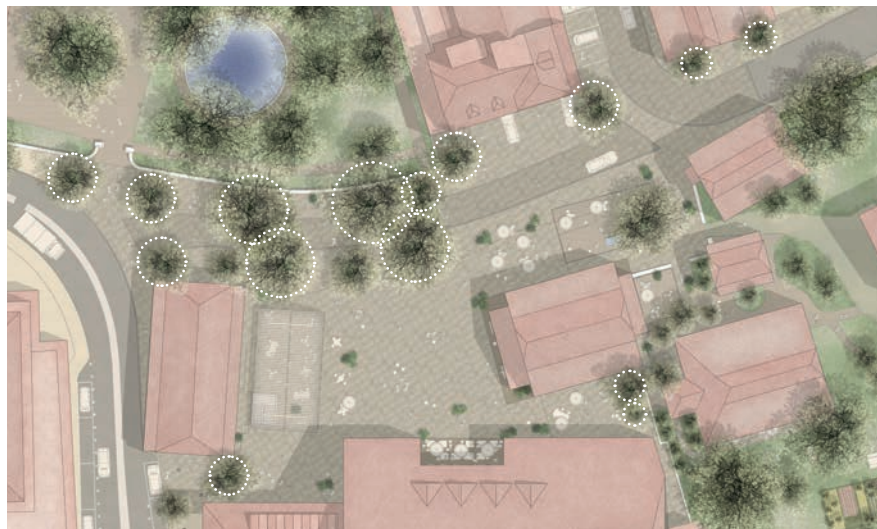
Baumbepflanzungen Dorfplatz mit 15 zusätzlichen Bäumen (weiss punktiert)
